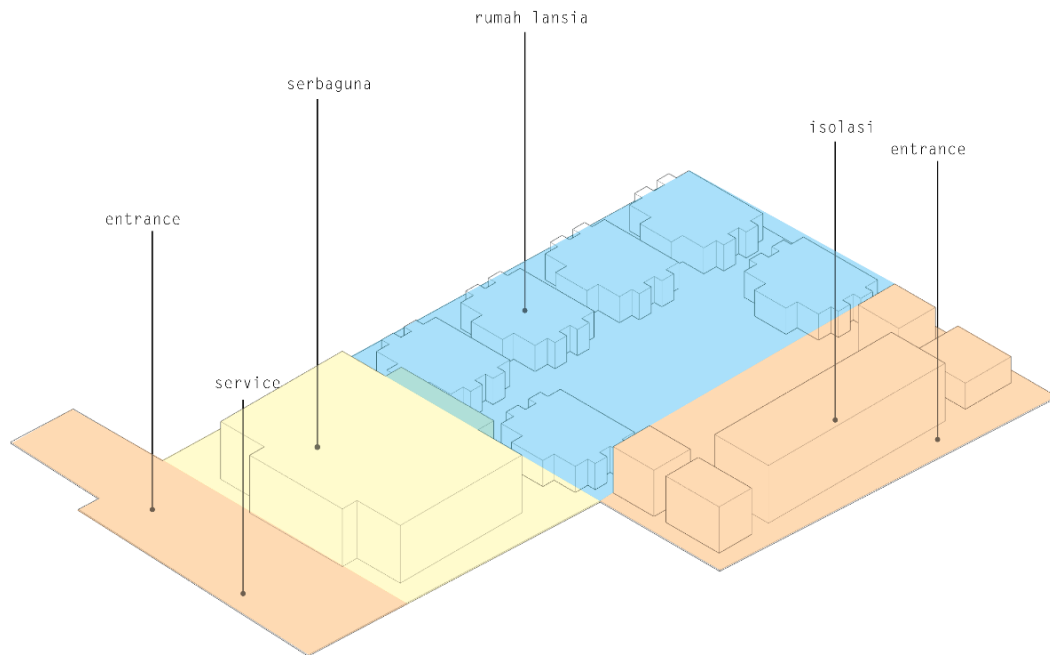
14 Skematik Bangunan Gedung Serbaguna
